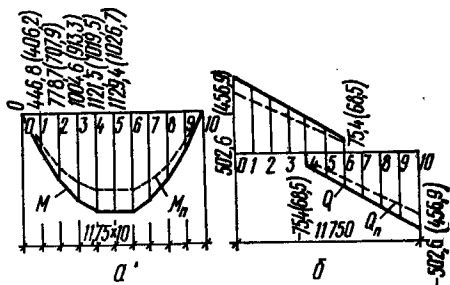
Расчетная схема подкрановой балки при расчете на два сближенных края
